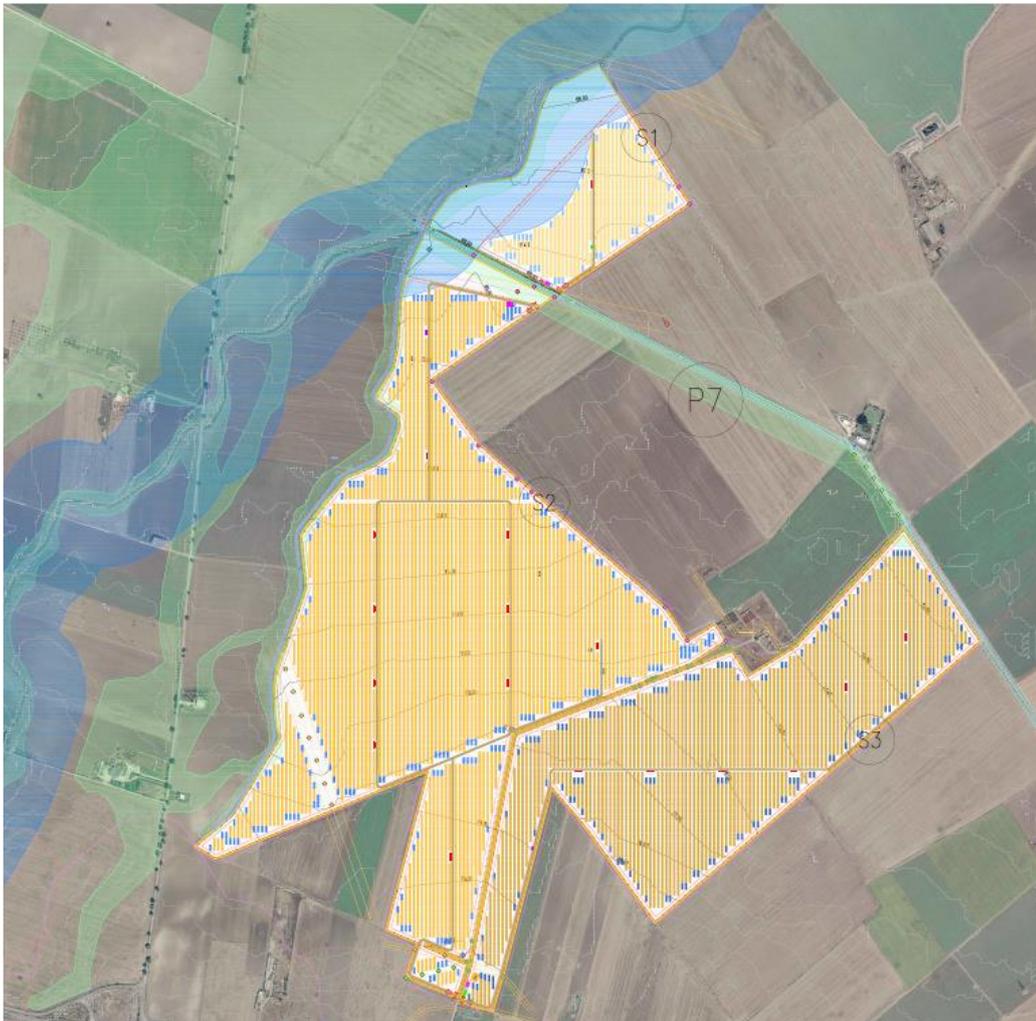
Risoluzione delle Interferenze nell'area di installazione dell'impianto fotovoltaico
